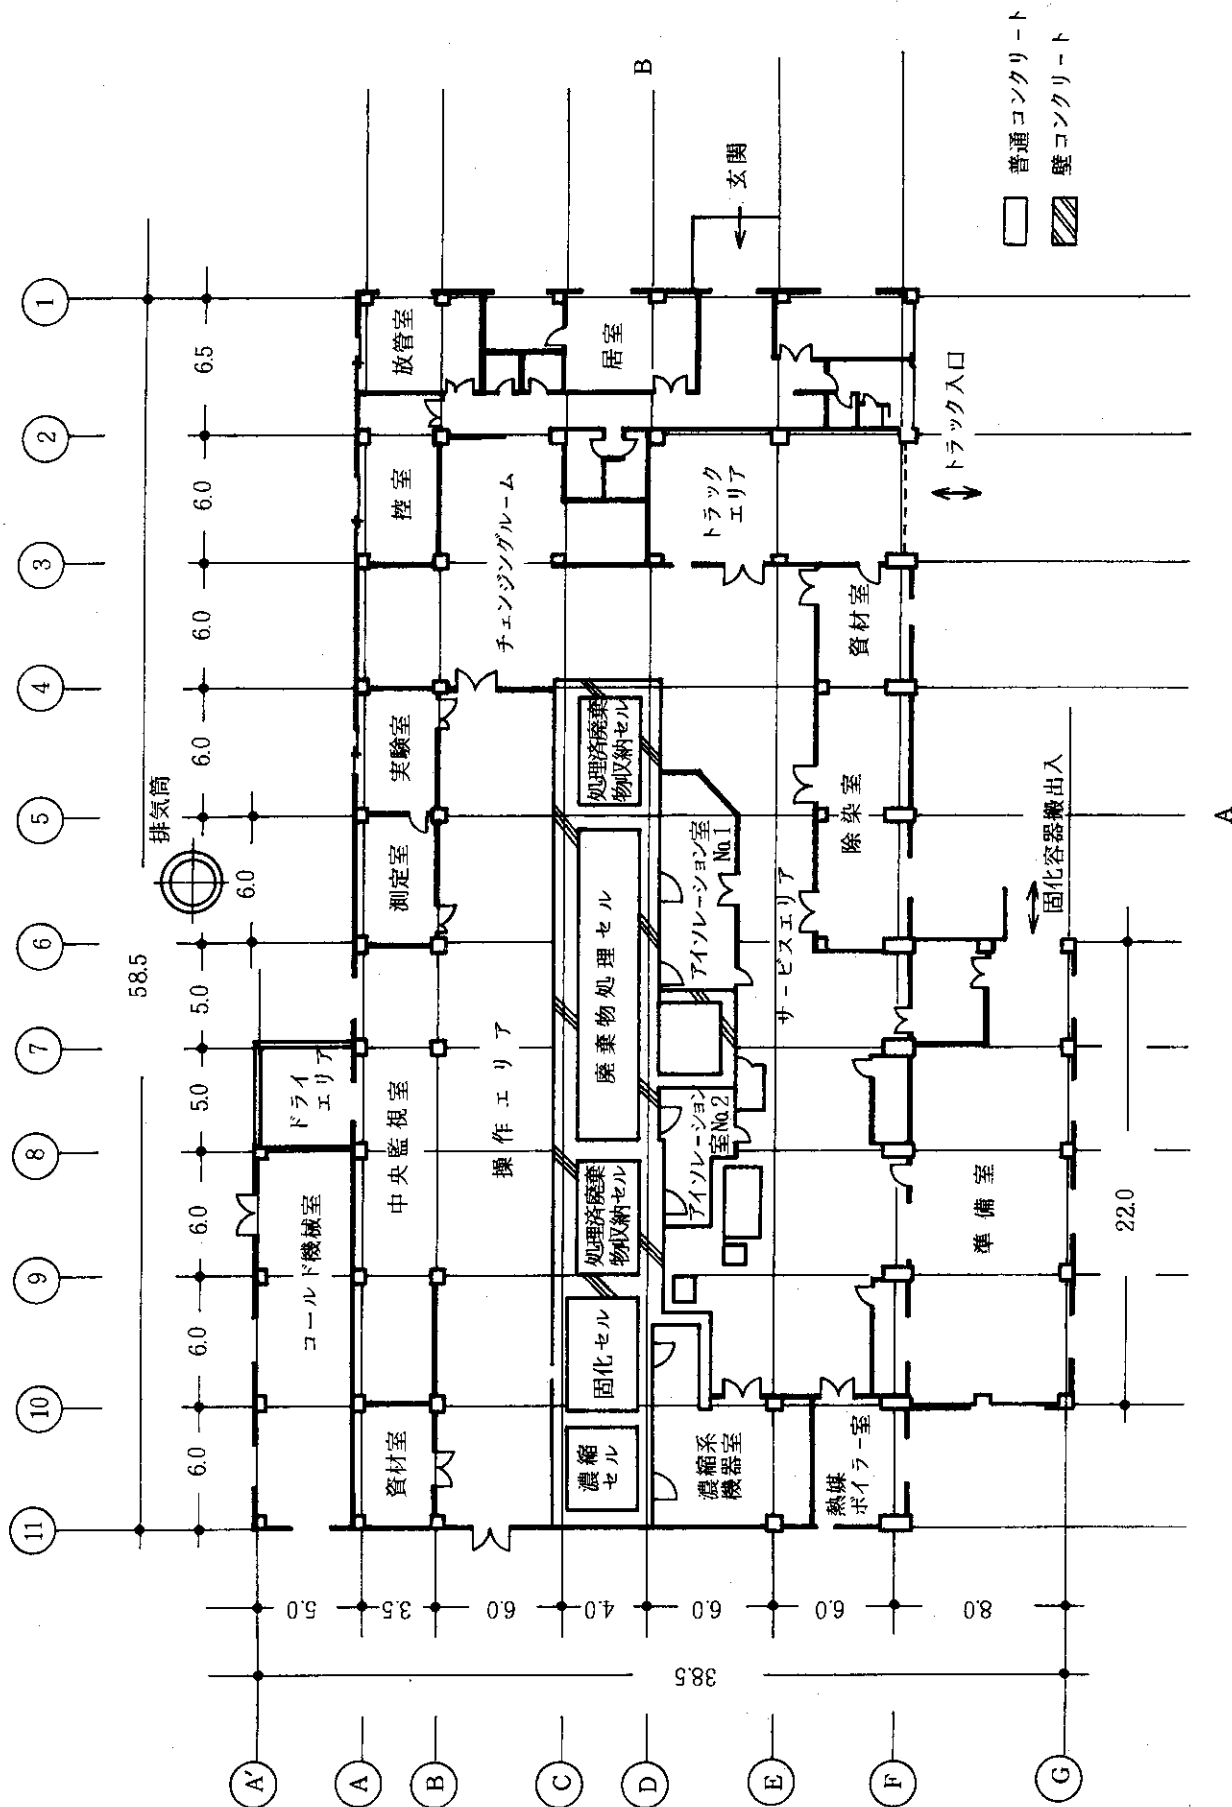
第2 廃棄物処理棟 1 階平面図 (単位 : m)
